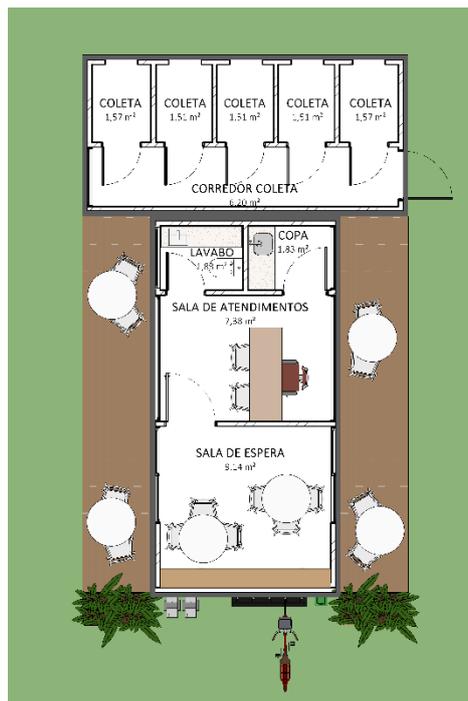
Proposta da Planta Layout e Planta Baixa do Eco ponto. Fonte: Autores (2023).
